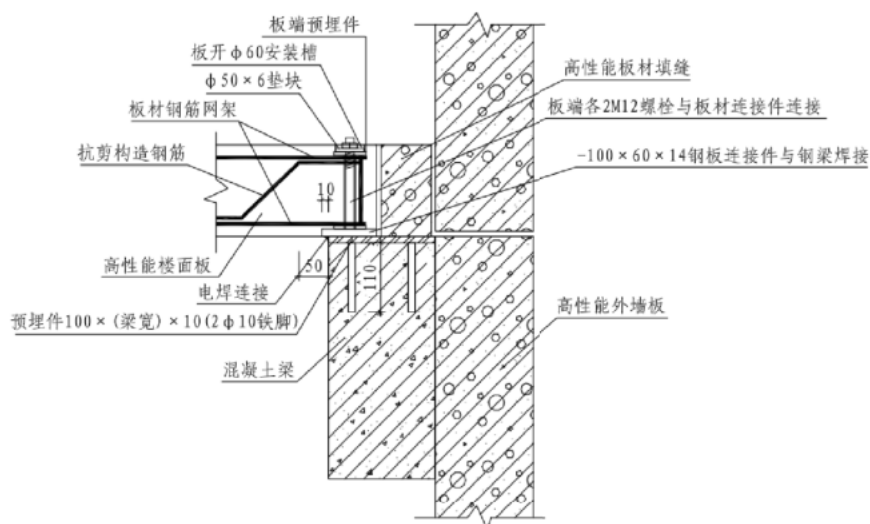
2 楼面板抗震支座混凝土梁连接构造（二）
